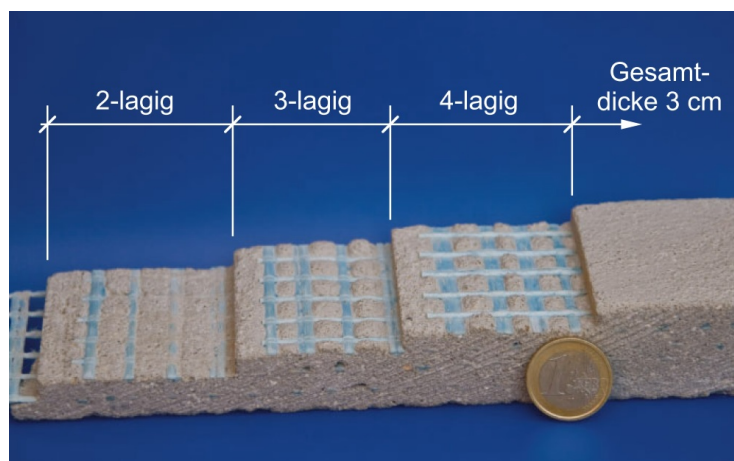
Textilbeton mit typischen Abmessungen [6, S. 15]
